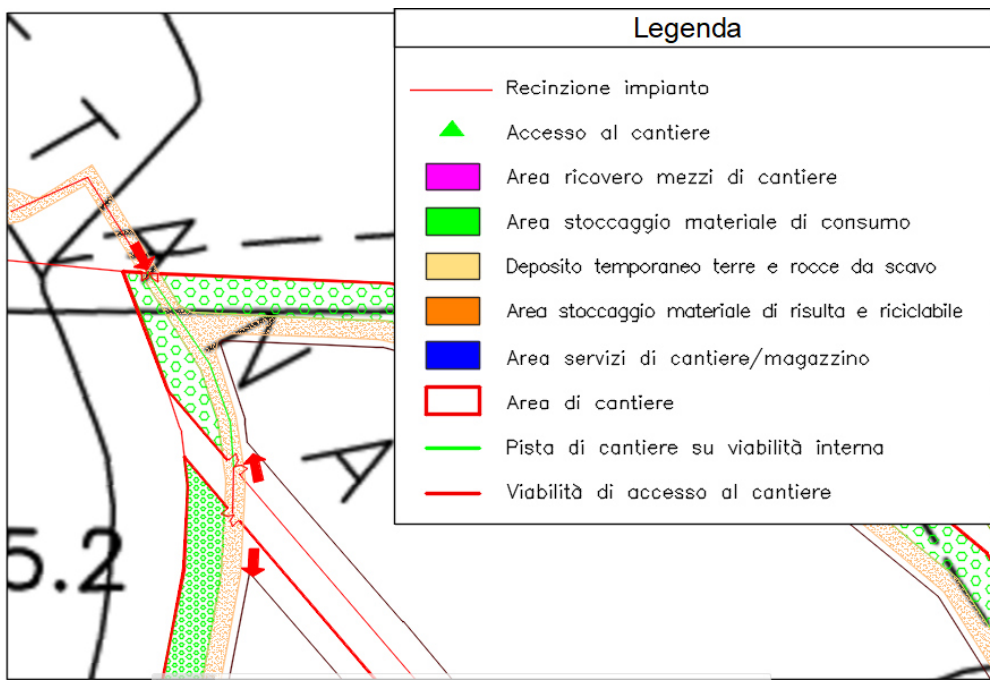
| Particolare accessi 1, 2 e 3 area di cantiere 1
